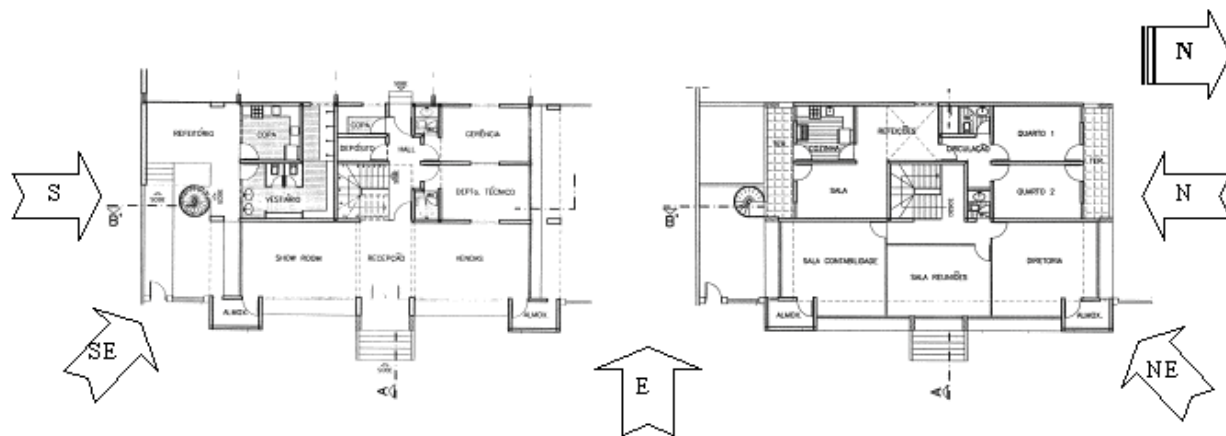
MARMOGRAN - Plantas-baixas Térreo e 1º Piso e esquemas de captação da ventilação natural
